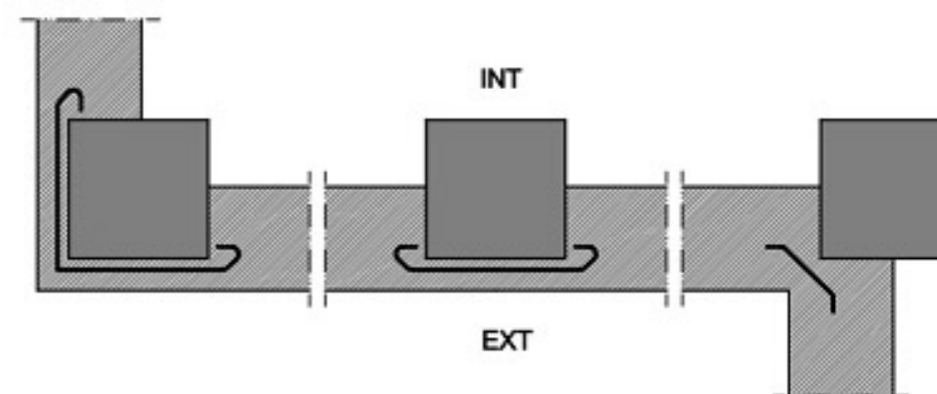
Ejemplo de encuentro de la fachada con los pilares
